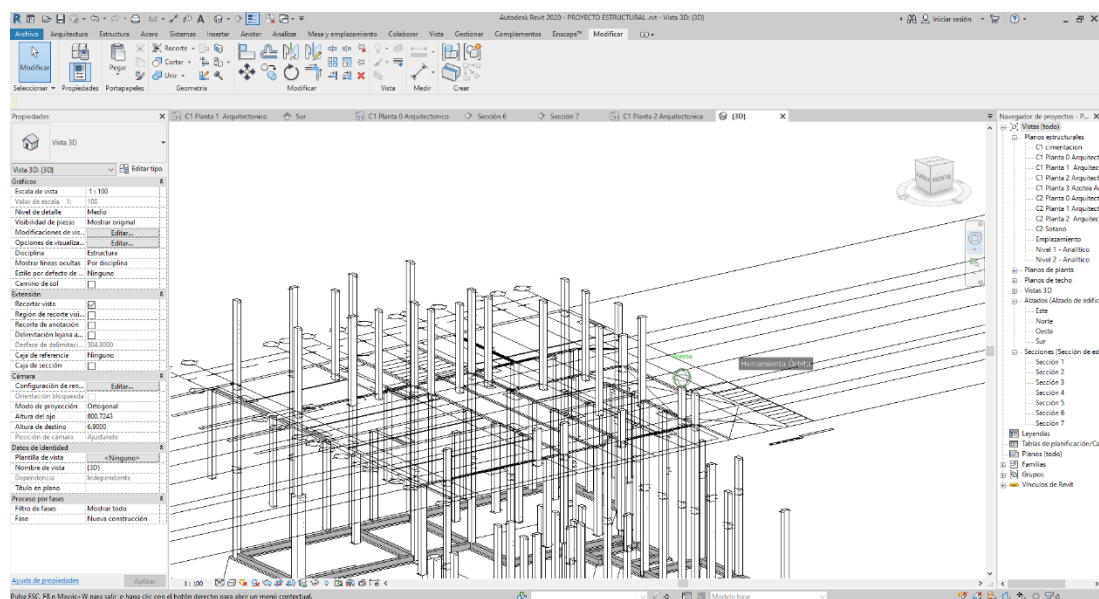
Desplante de columnas Casa 1. Fuente: (Elaboración propia Cajica, J. 2020)
